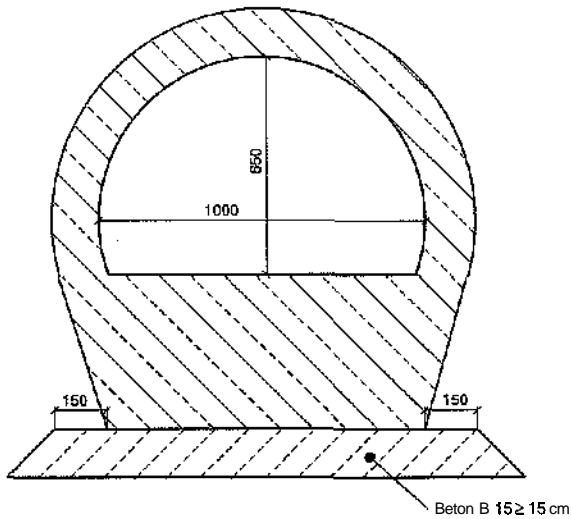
Prinzipskizze für den Einbau eines überschütteten Betonrohrs mit Kreisquerschnitt und Fuß nach DIN 4262 mit monolithisch eingebauter Lauffläche.
